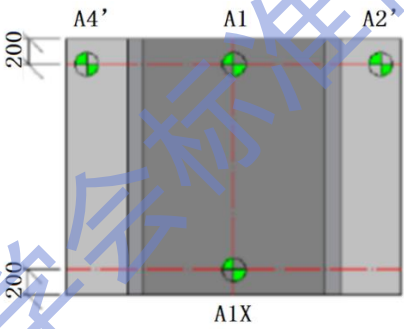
测点立面布置示意（以北肢为例，尺寸单位：mm）
